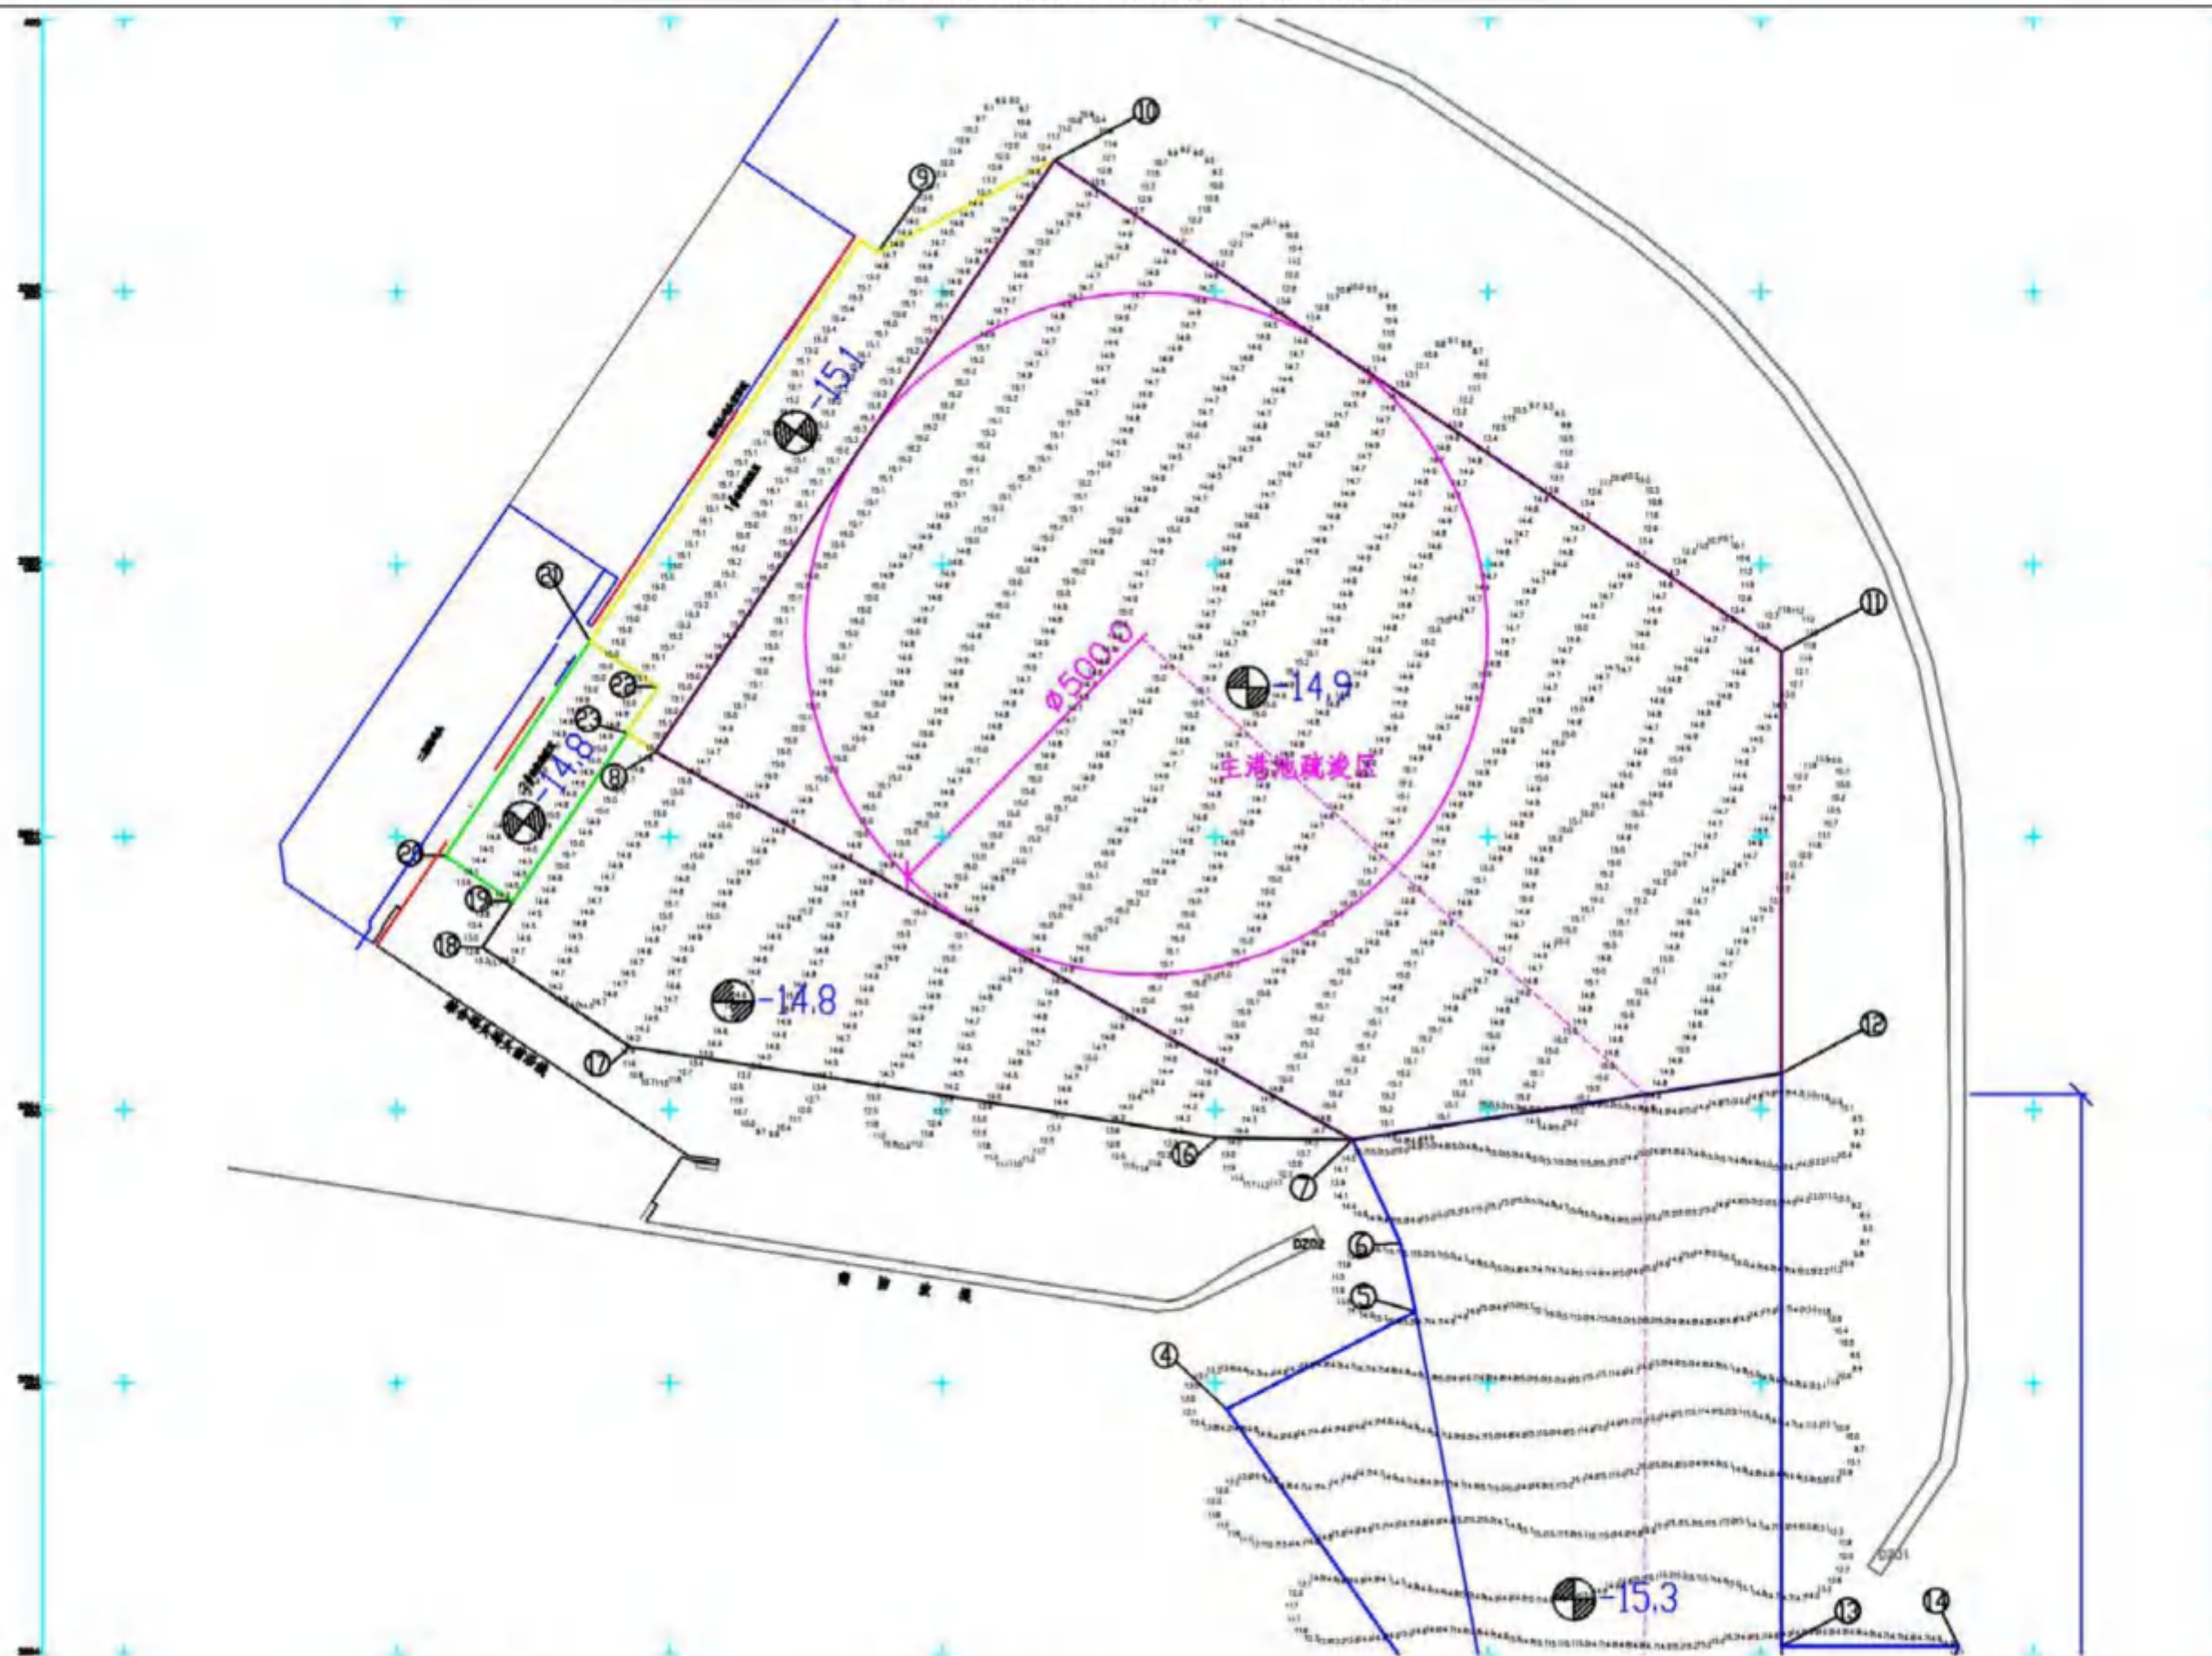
施工前疏浚范围水深地形放大图 1
